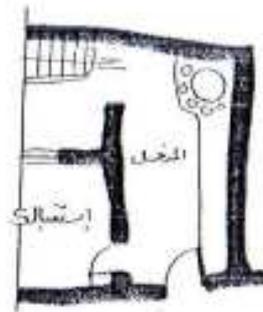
مسقط أفقي للطابق العلوي لدار السنڭادية
